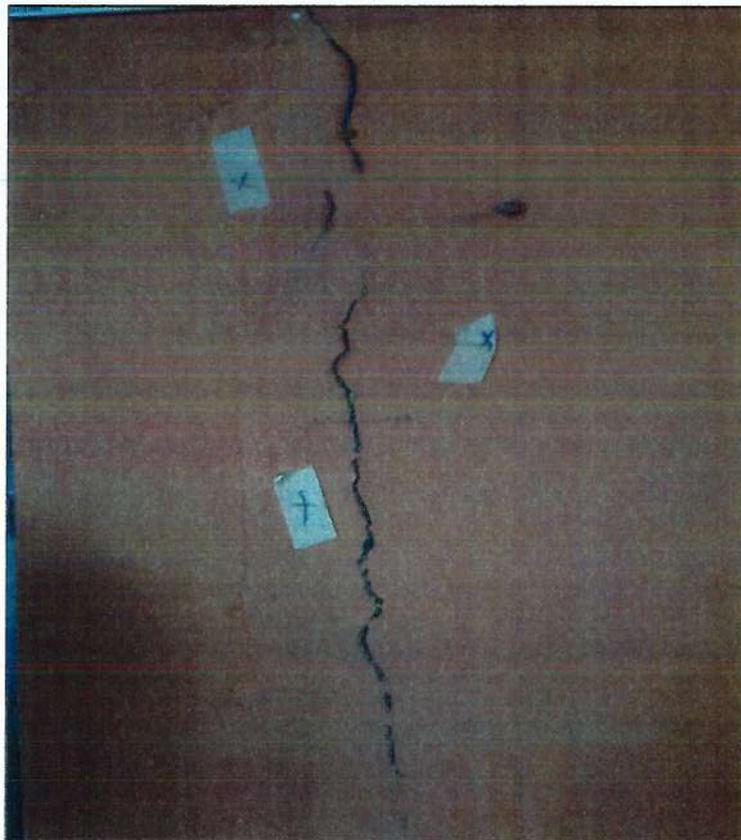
Vivienda cerca calle José María Alemán fisurada / Ciudadela Solanda
